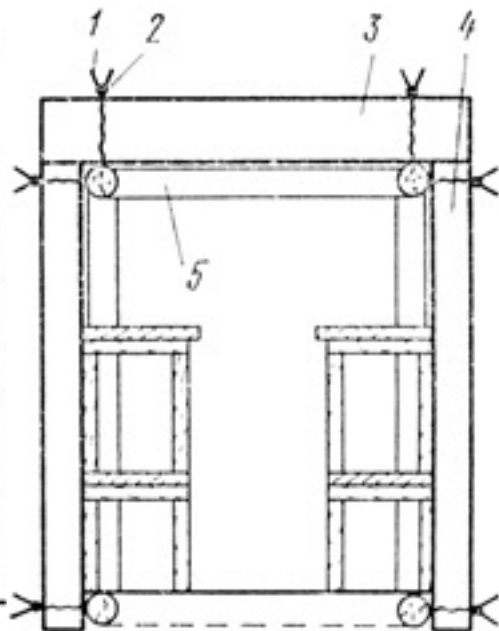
Поперечный разрез убежища, возводимого с использованием для устройства стен железобетонных плит, устанавливаемых на ребро: 1 – проволочные скрутки; 2 – продольный арматурный стержень; 3 – железобетонная плита покрытия; 4 – стеновые железобетонные плиты; 5 – поперечные рамы
